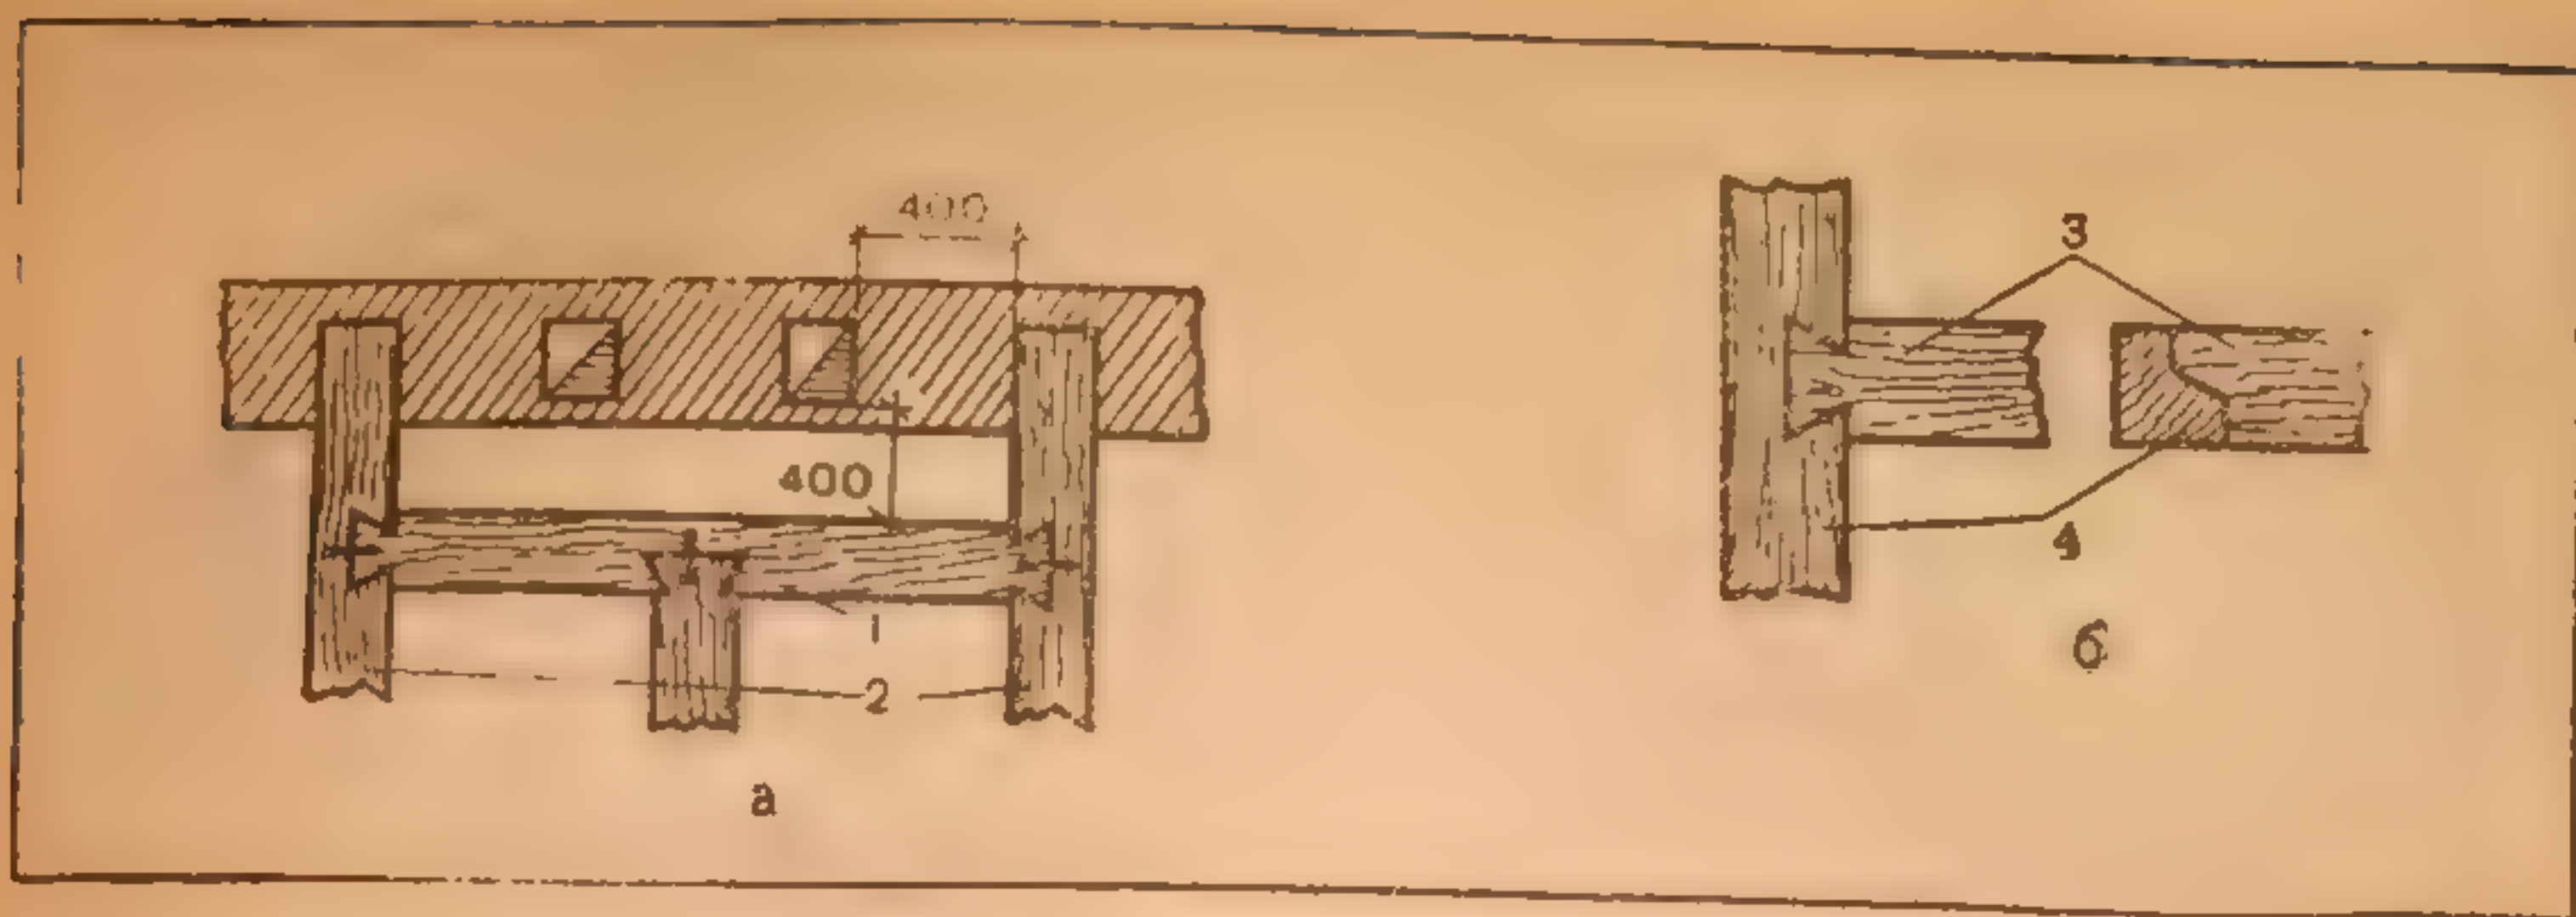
Заделка концов деревянных балок междуэтажных перекрытий в стену толщиной в 2 кирпича:
